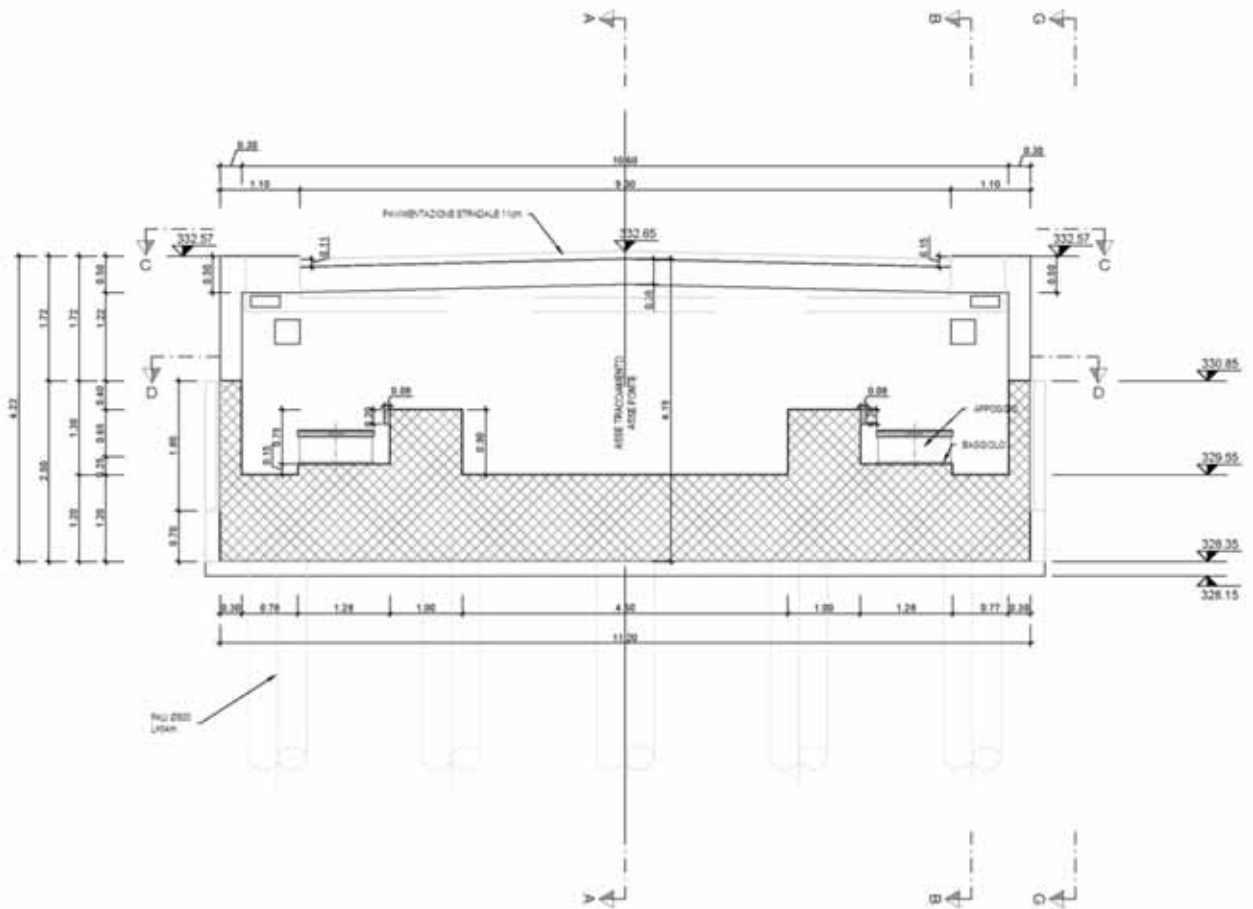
SPALLA A – Sezione longitudinale
